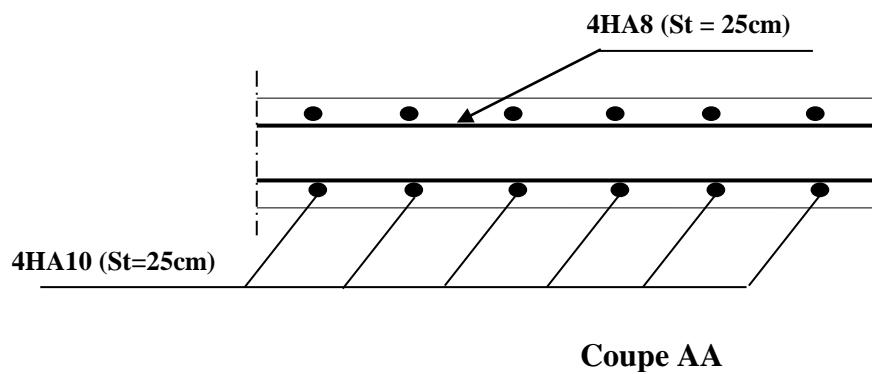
Plan de ferrailage de la dalle salle machine
